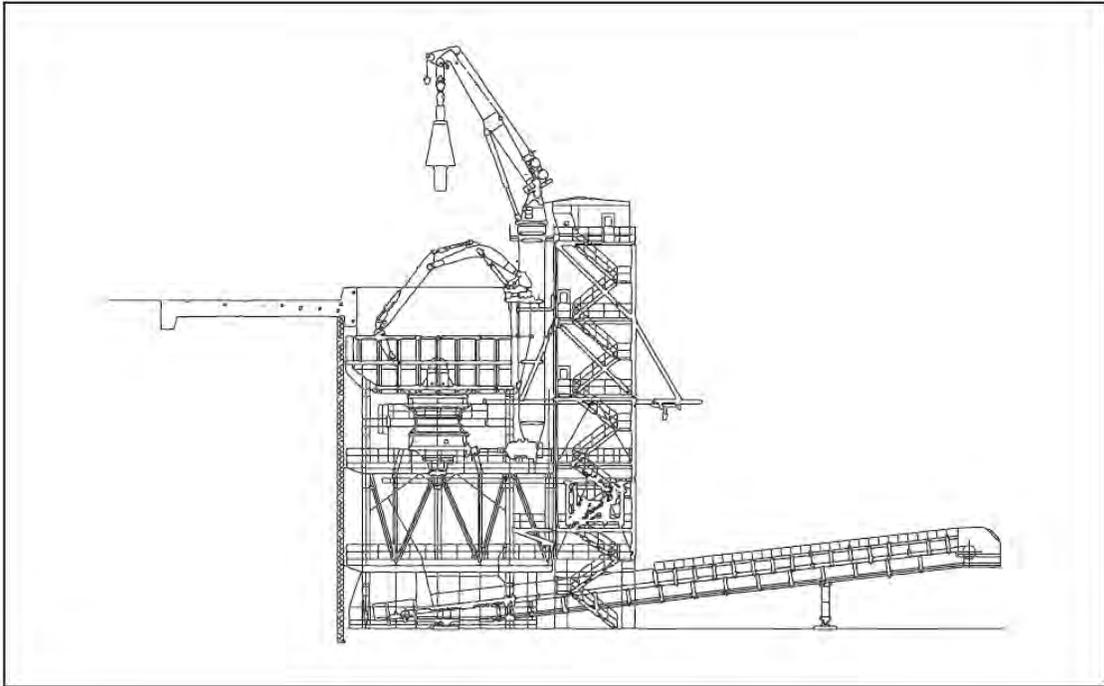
3 Planta chancadora semi - móvil de descarga directa. Fuente (Darling, 2011
